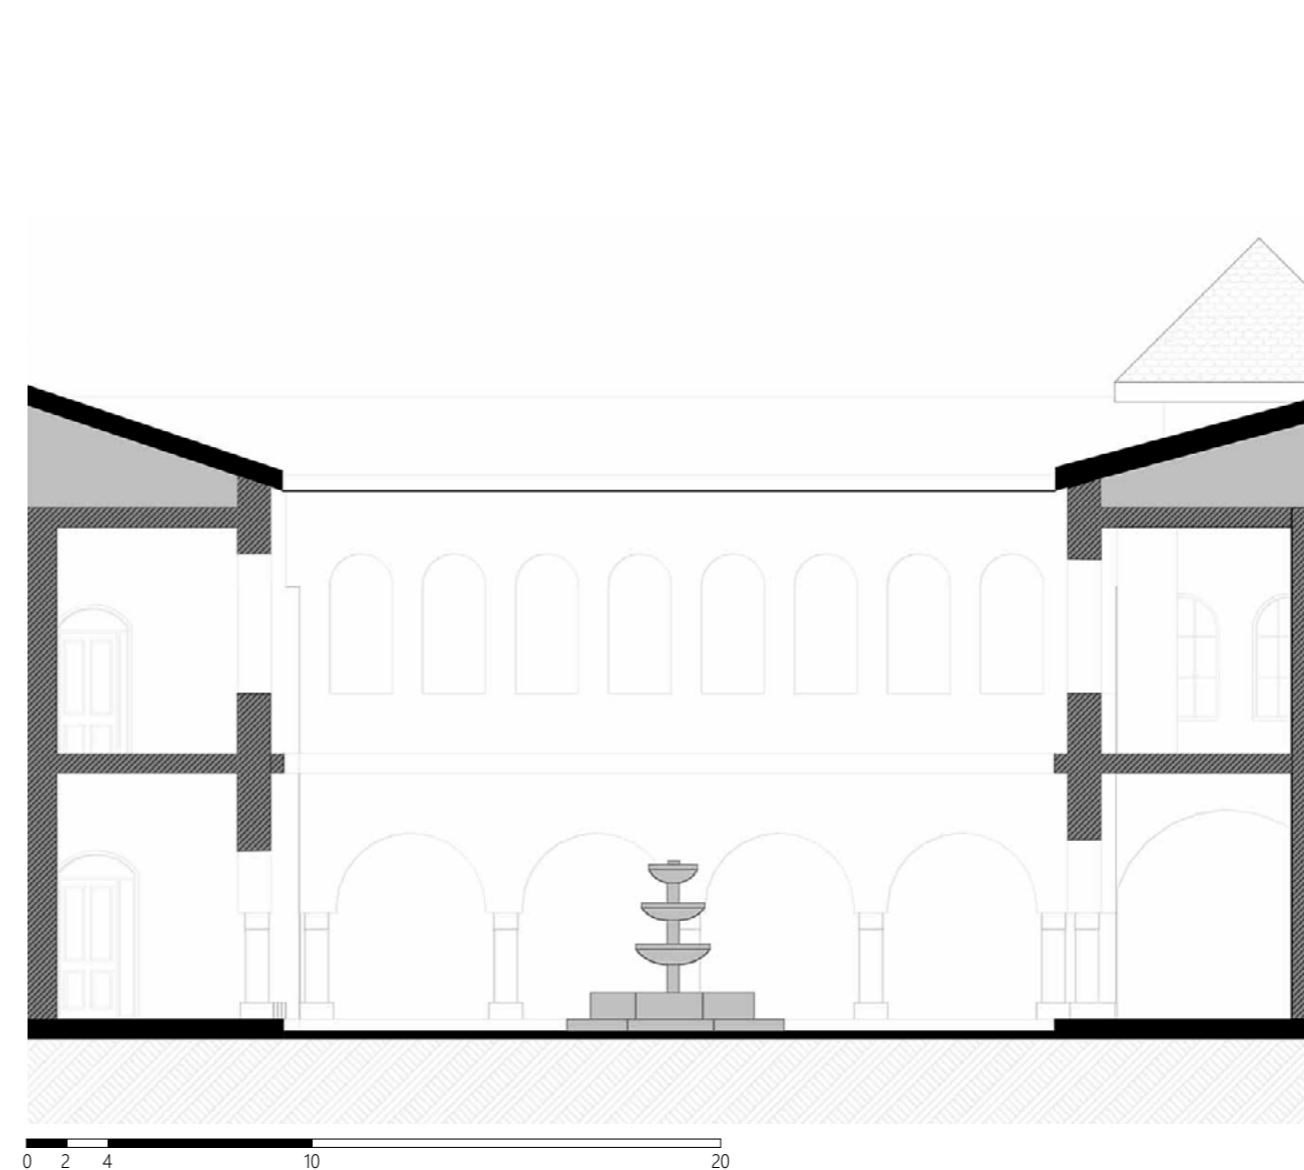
Estado actual alzado bloque de talleres. Elaboración propia.
